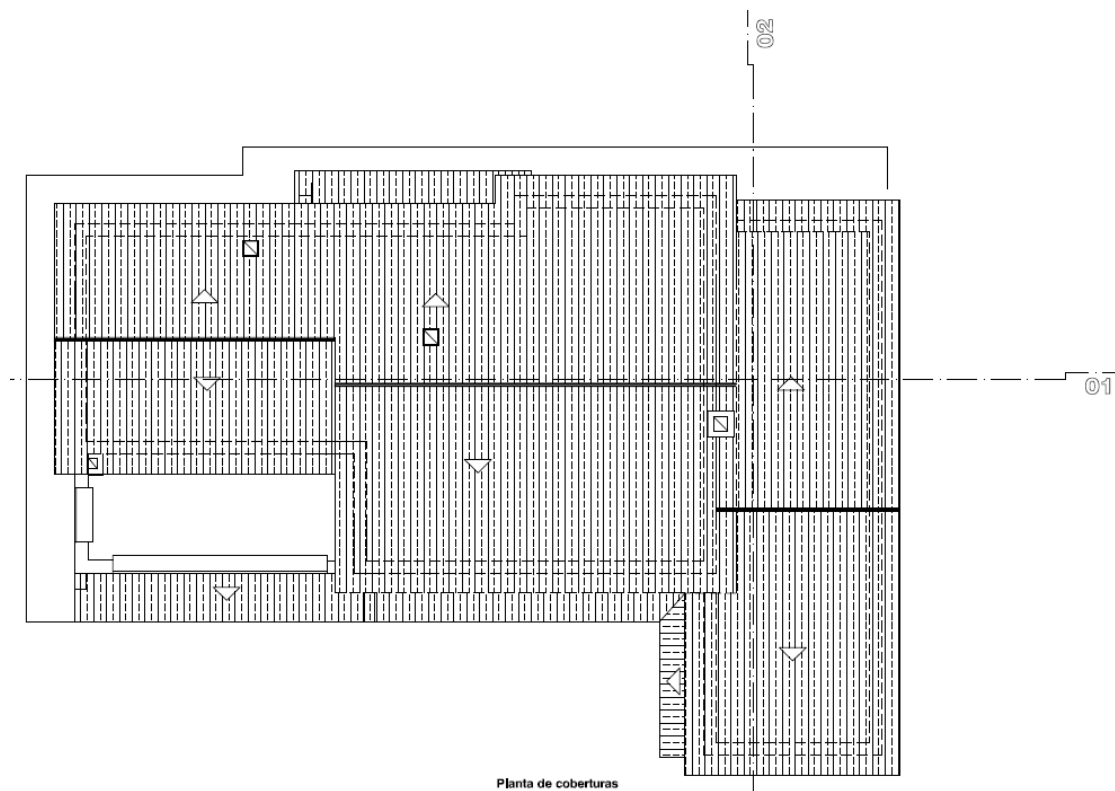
Planta de coberturas do edifício de habitação em fase de projeto.
